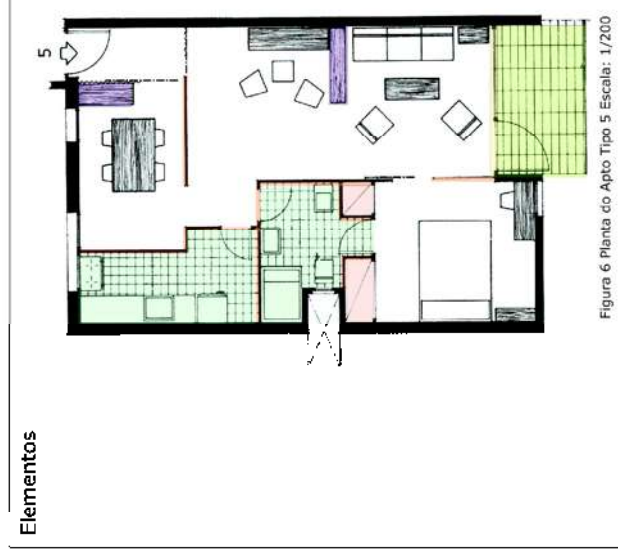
Planta do Apto Tipo 5 Escala: 1/200
